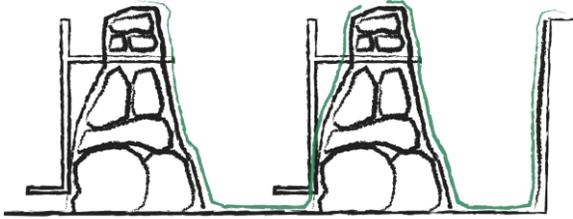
Colocado y habilitado de lona de impermeabilización para las cámaras de los filtros.
